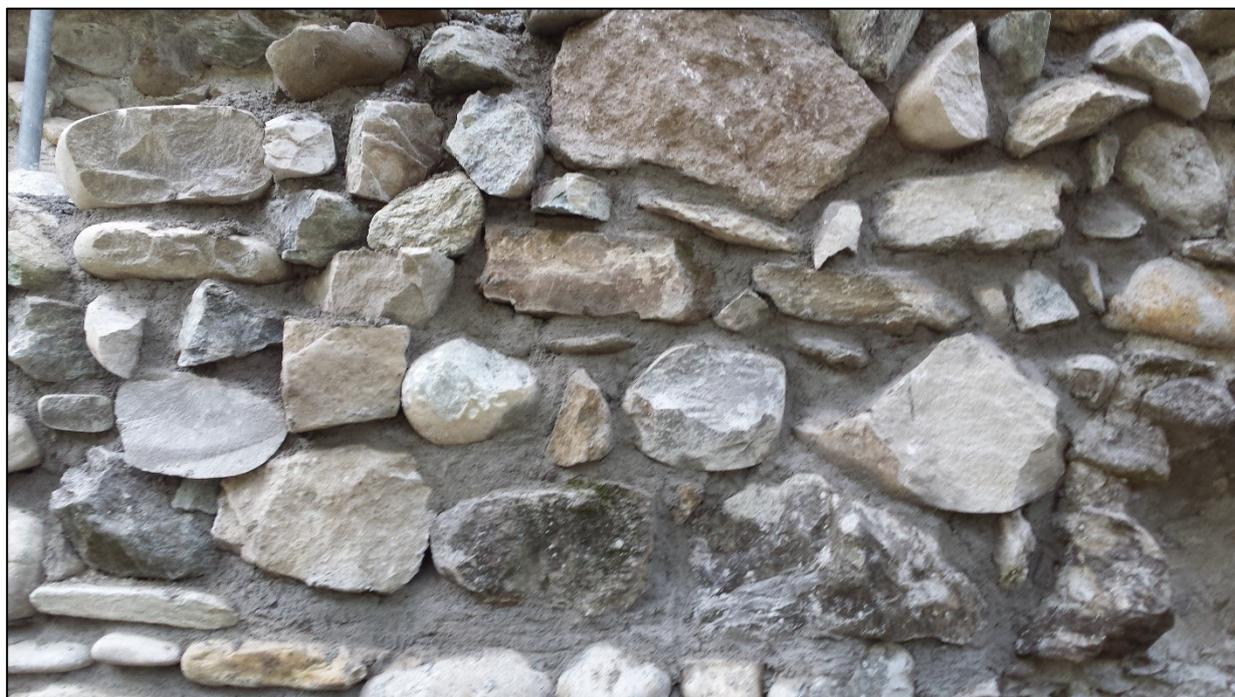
Consolidation de la courtine ouest. Photo: R, Racineux, Construction Perret SA.
